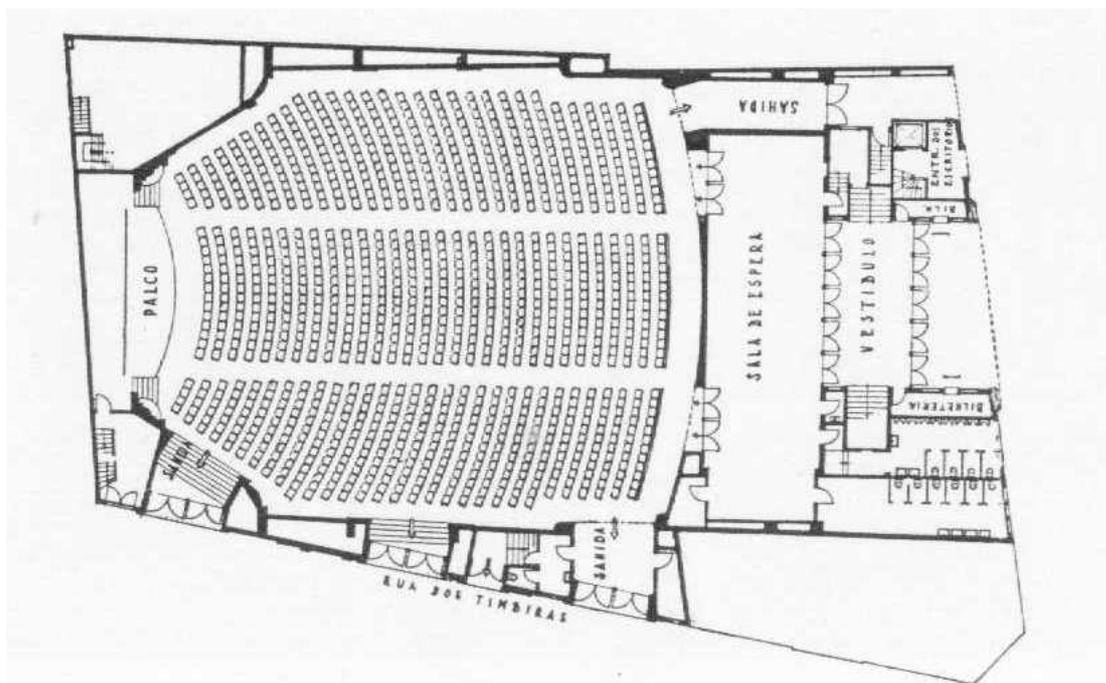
Cine Metro São Paulo - Planta do pavimento térreo.
